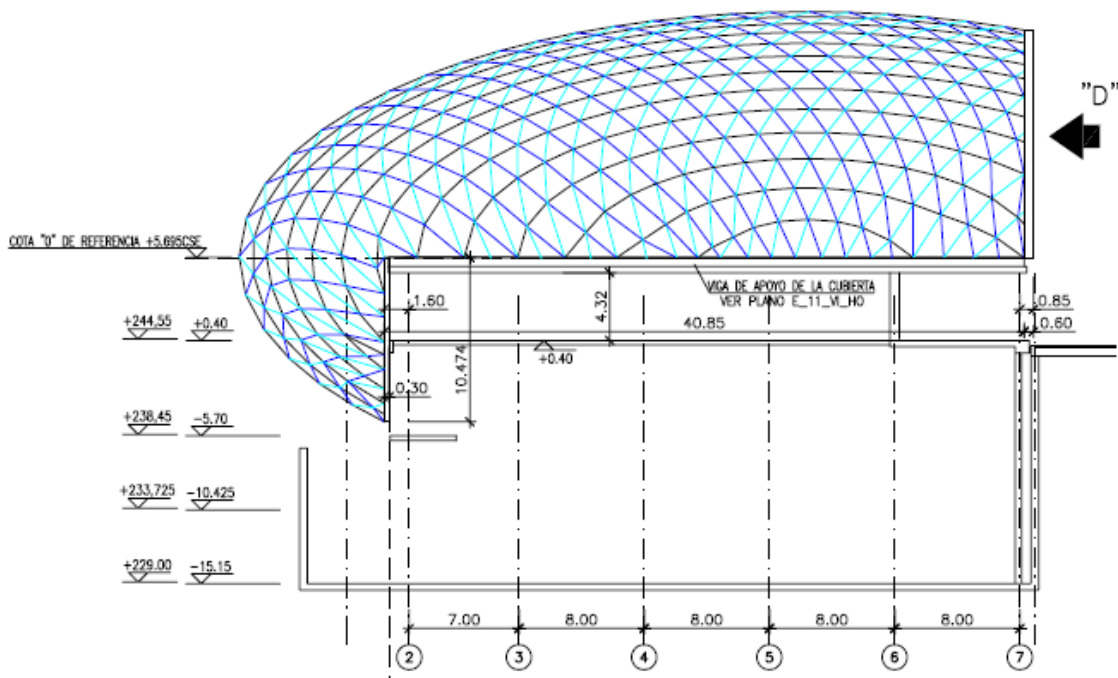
Esquema de apoyo de la cubierta en la estructura de hormigón armado del edificio.
